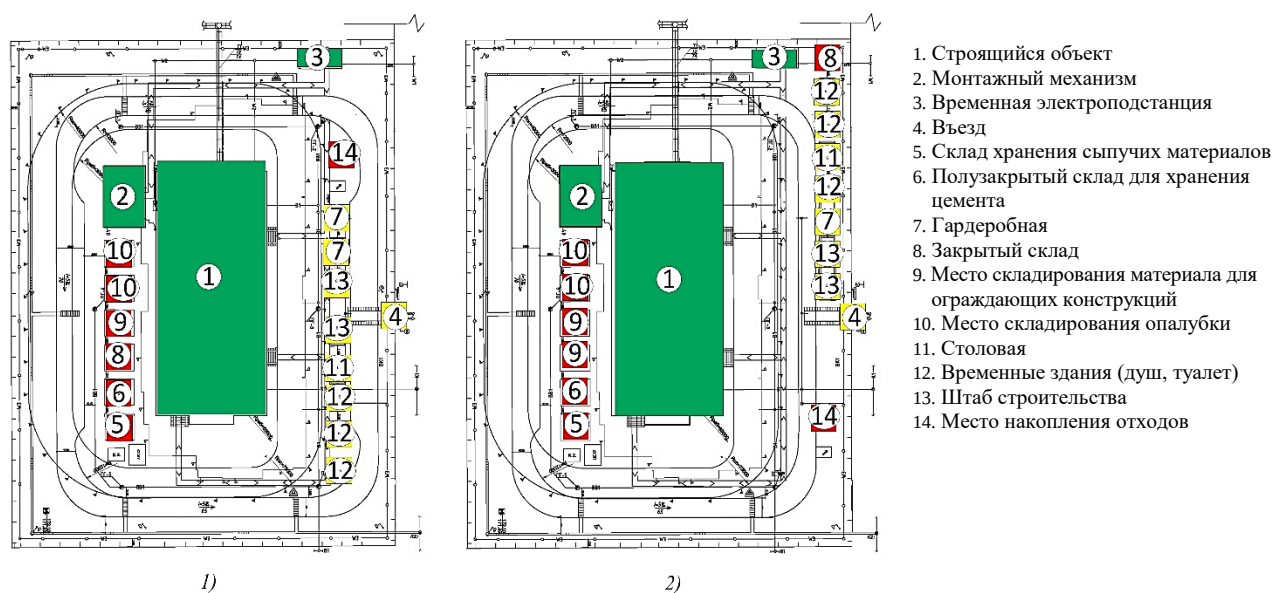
Планировка строительной площадки: 1 — первоначальный план; 2 — оптимизированный план
